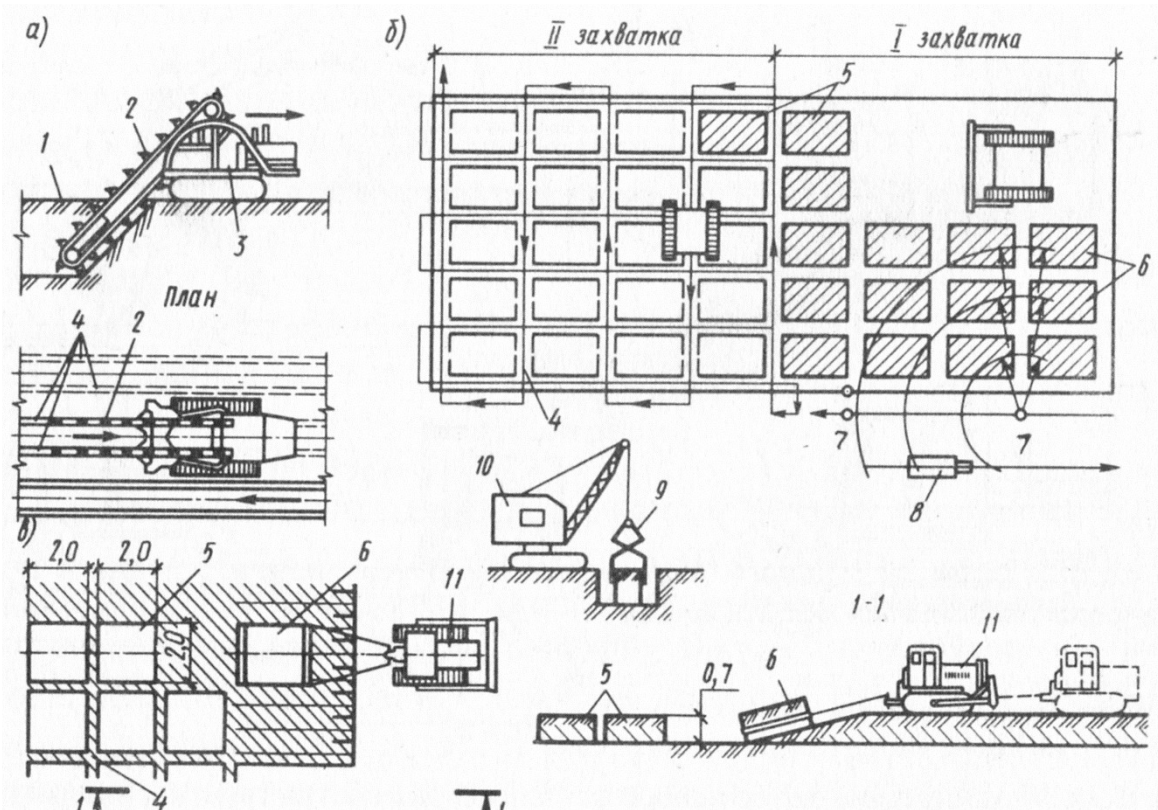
Схема блочной разработки грунта (размеры в м):
